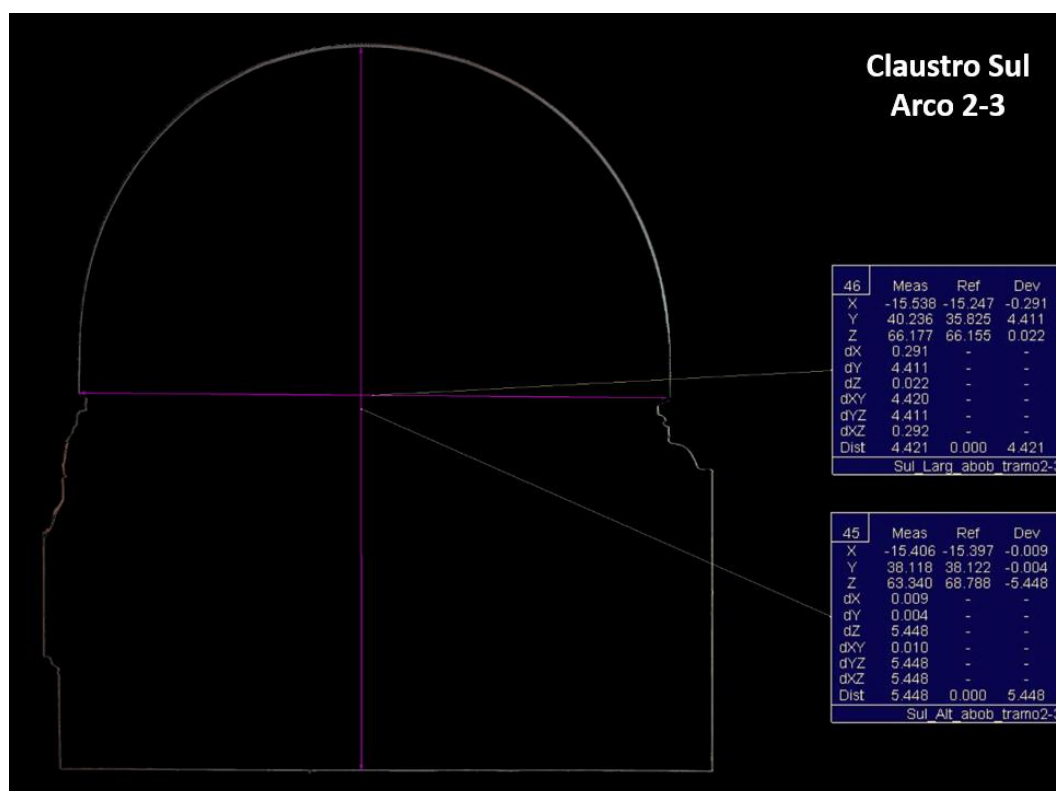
Corte transversal do Arco 2-3 do claustro Sul de D. Dinis.
